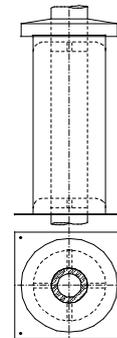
Aufbau Stulprohr mit integrierter Ablufführung
